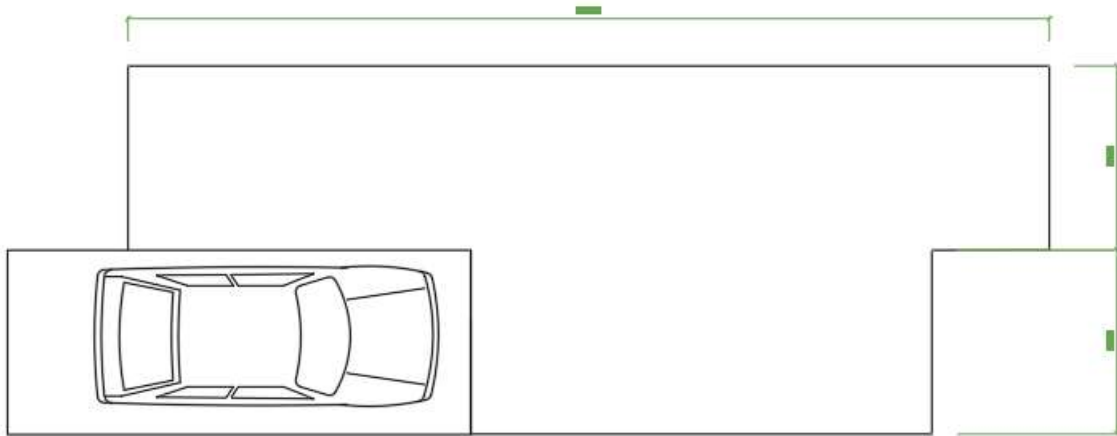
Esquema opción 1. Wilson Lozano. 2025
